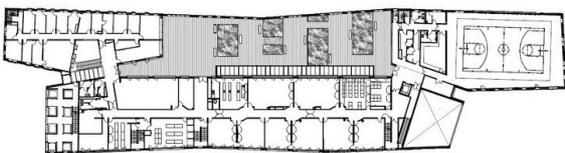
/50_ Pianta piano primo e piano secondo del Centro di formazione progettato ad opera degli architetti Brenac & Gonzalez a Gennevilliers, Francia, 2012, fonte www.archdaily.it
